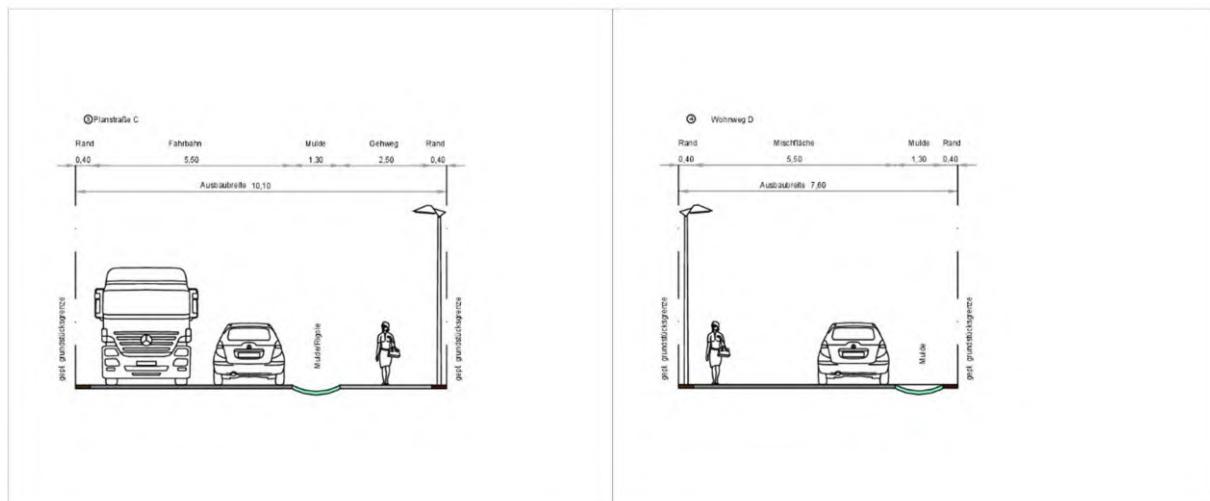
Regelquerschnitte (Skizze) B-Plan Planstraße C und Wohnweg D
